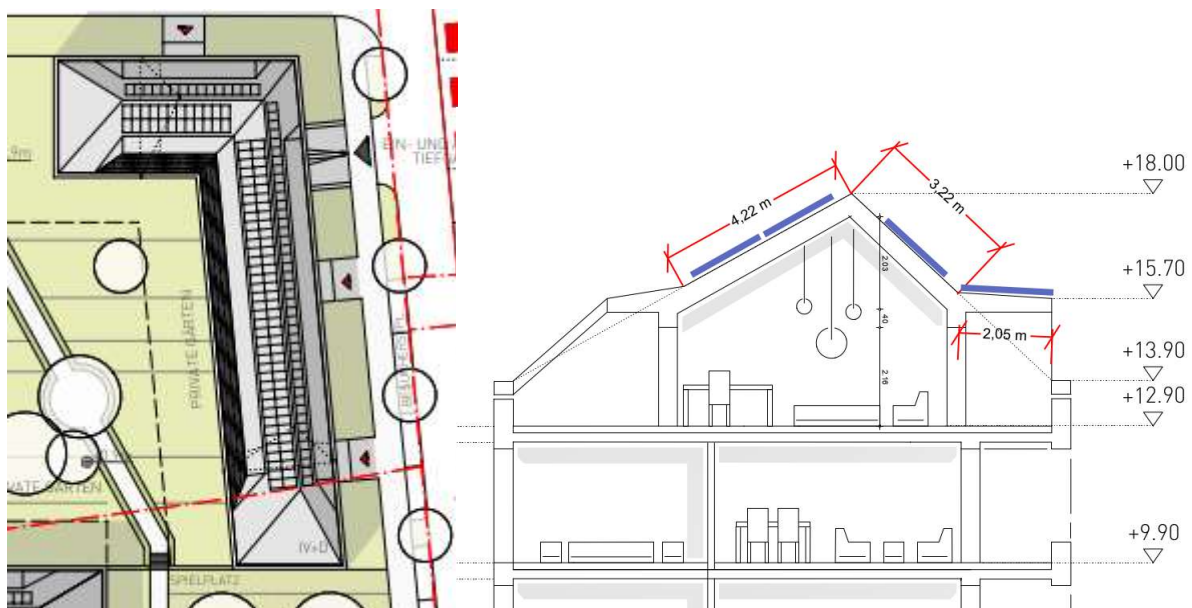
Ausschnitte aus Lageplan und Schnitt vom 24.04.2023 mit Eintragungen zu Maßen und PV-Fläche
